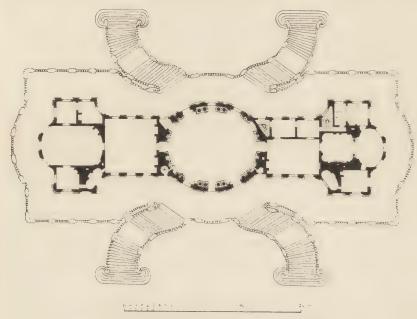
Schloss Solitude bei Stuttgart. Grundriss.
